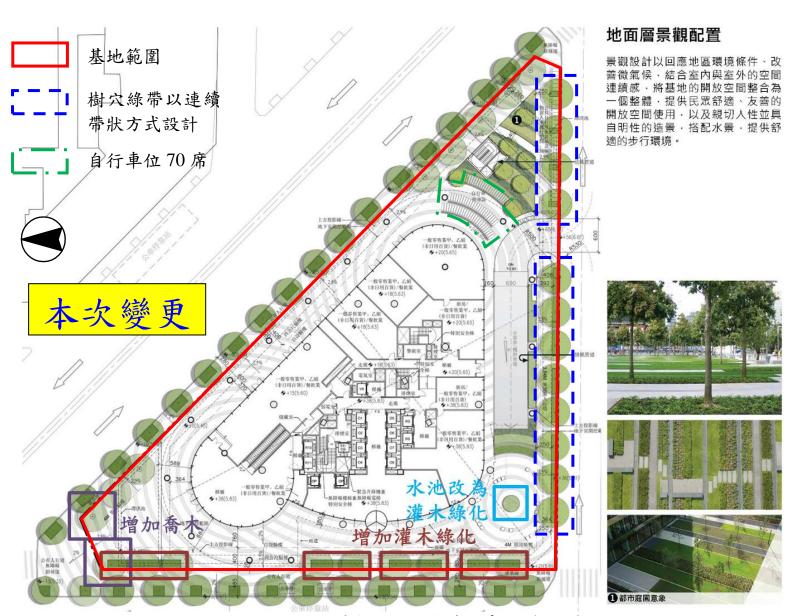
1F 平面景觀配置及動線示意圖(本次變更)
